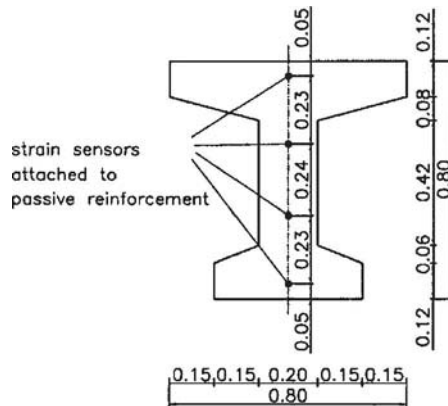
Section de la poutre étudiée par Unger et al. [53]
